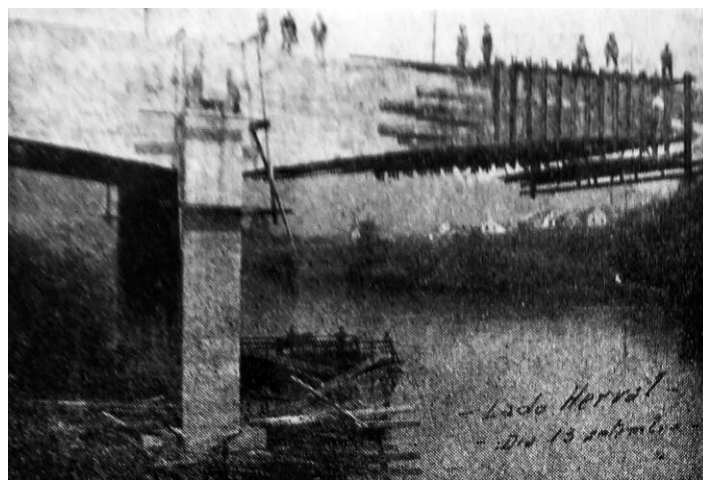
Detalhe da construção. FONTE: CONCRETO, 1945.
